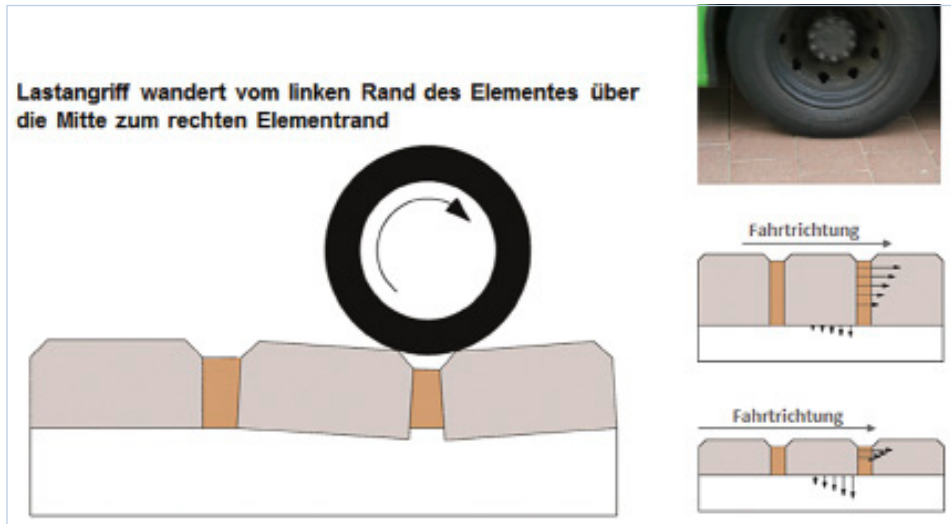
Bewegungsablauf beim Überfahren einer Pflasterfläche, Steinrand [Quelle: Buchholz]
